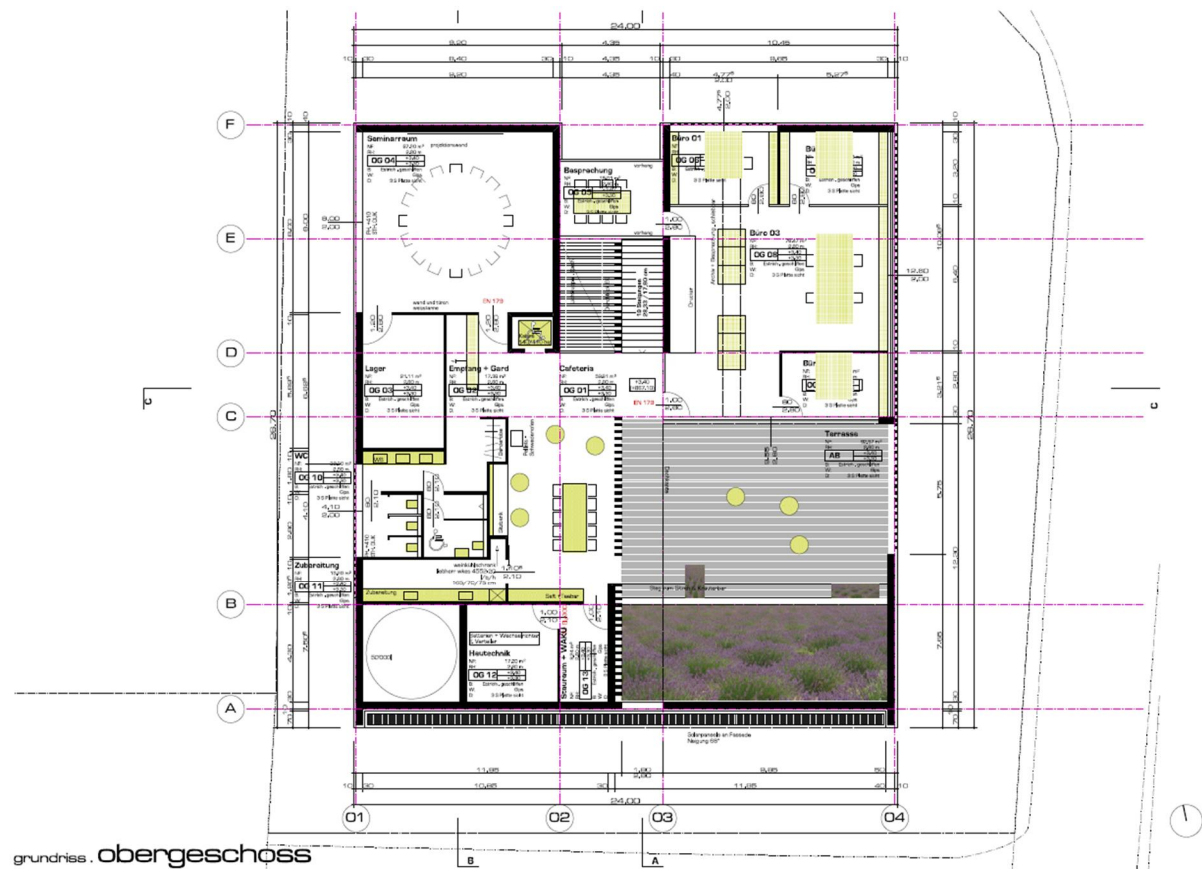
OG Grundriss Einreichung Aromacampus (Ventira Architekten)
